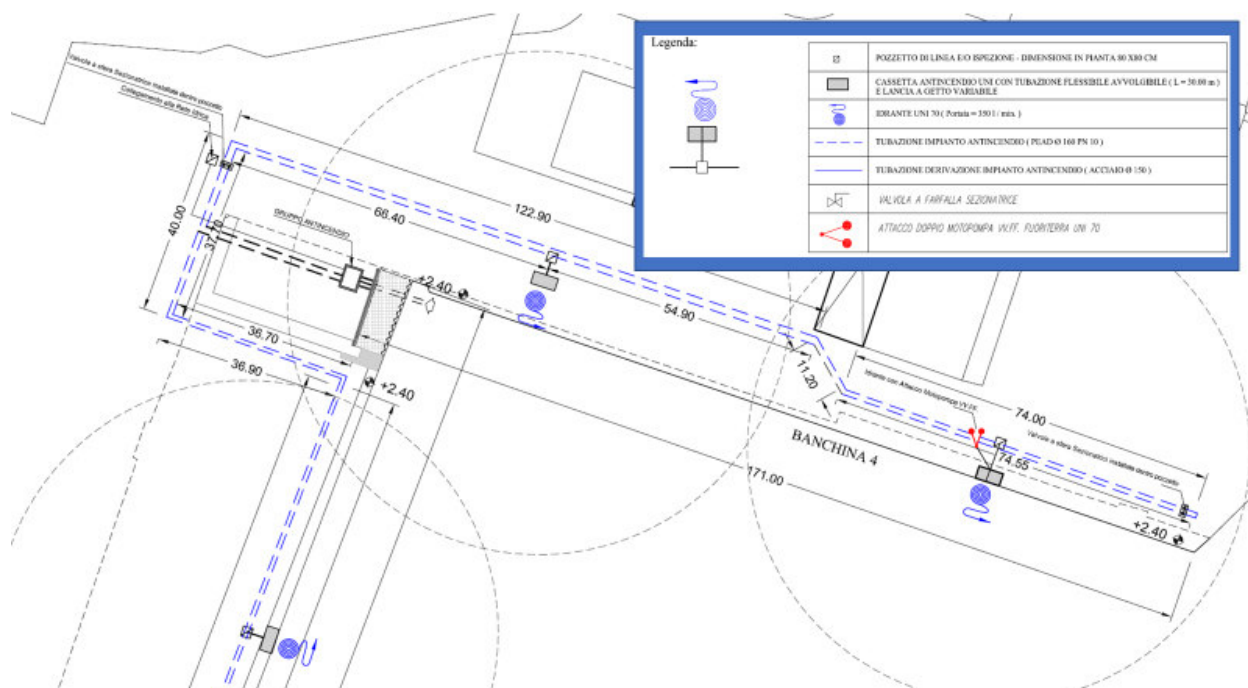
Stralcio planimetria EEG06006T2302 - Piazzale IV Novembre e zona cabina CEB
